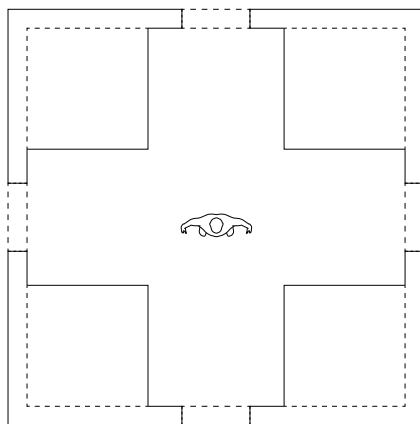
Pos. I.VI | Grundriss – M.1:100
